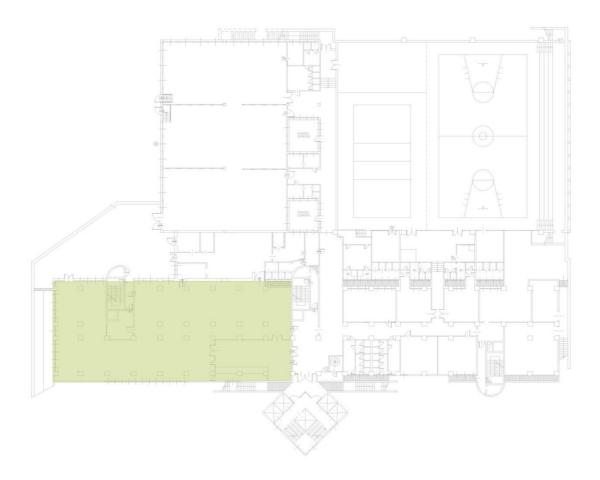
Pianta piano interrato – CAG (Centro di Aggregazione Giovanile) "Icaro"
